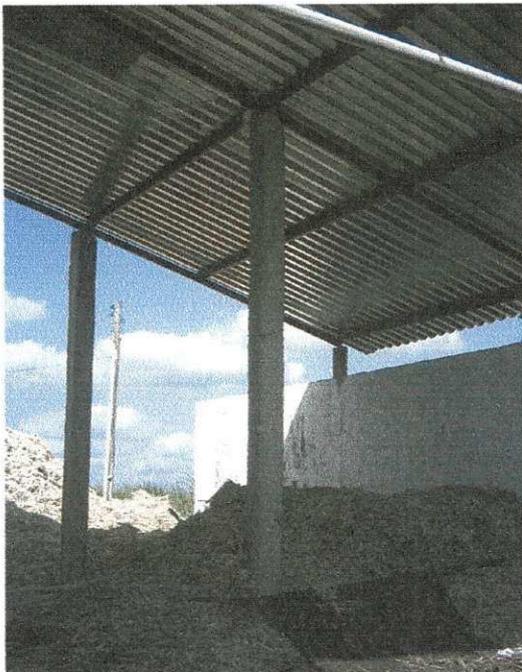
Pilares de concreto com cobertura metálica do engenho Bela Vista.
